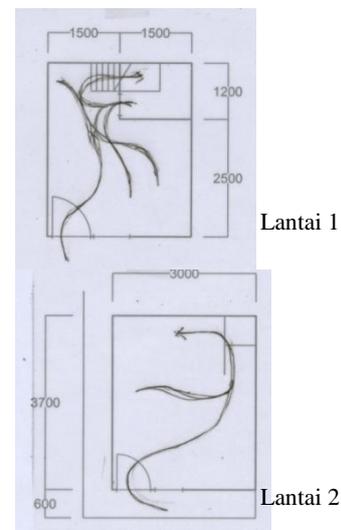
Denah lantai 1 rumah mbak Ir
